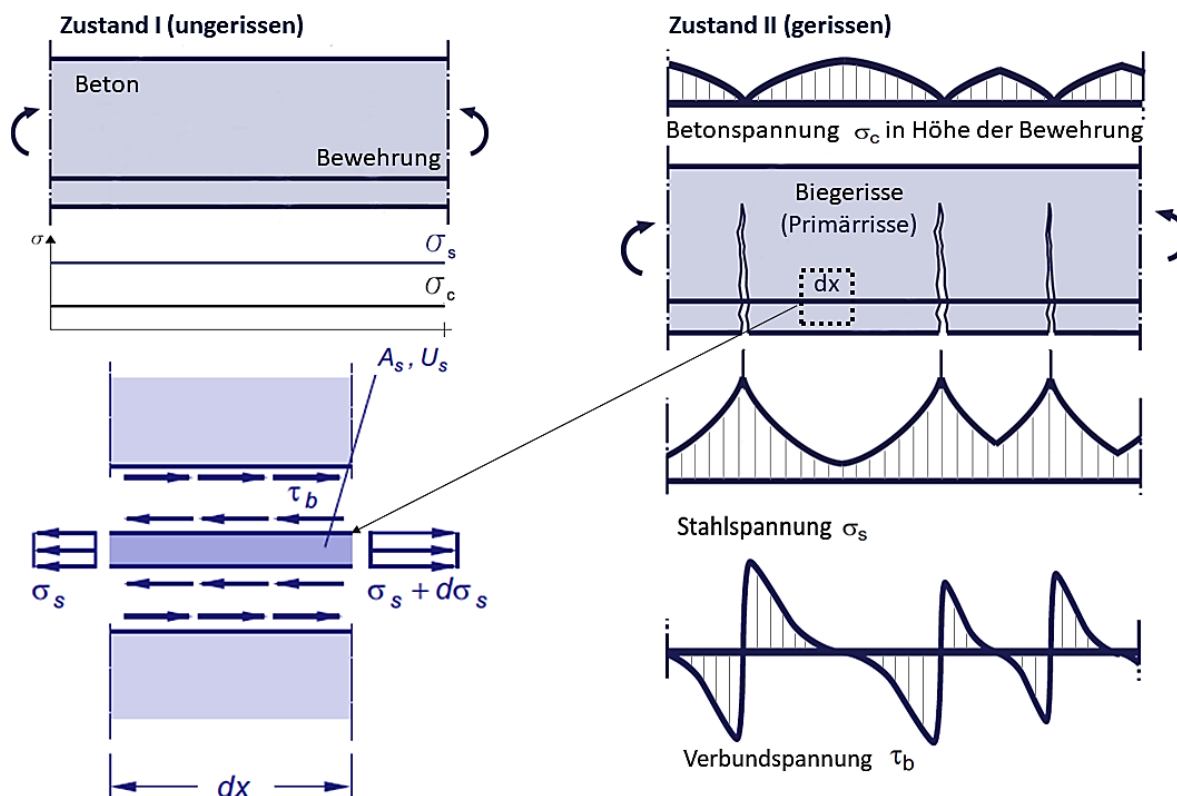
Prinzip der Rissbildung und Spannungsverteilung in Stahlbeton unter Biegebeanspruchung ($M = \text{const.}$).
